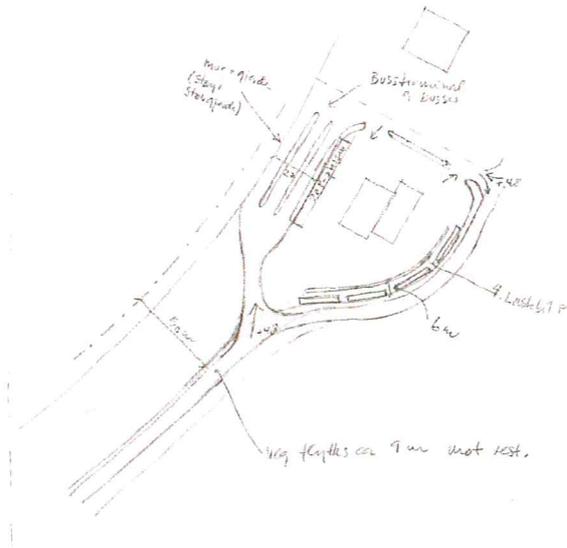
Lokaliseringsalternativ Vollan bro Nord med nåværende E6/E8. (Foto: Viggo J. Dale).
